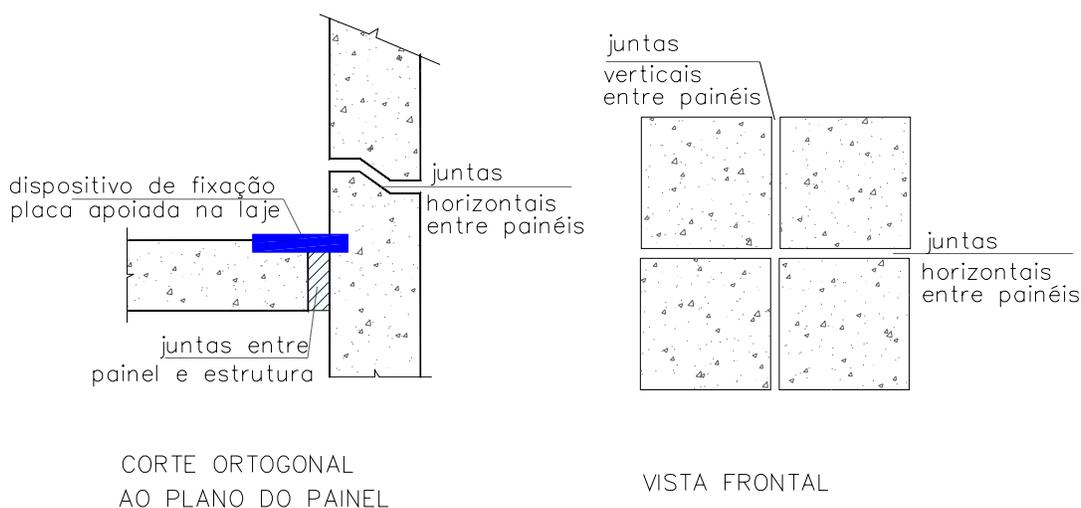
Juntas entre painel e estrutura e juntas entre painéis
